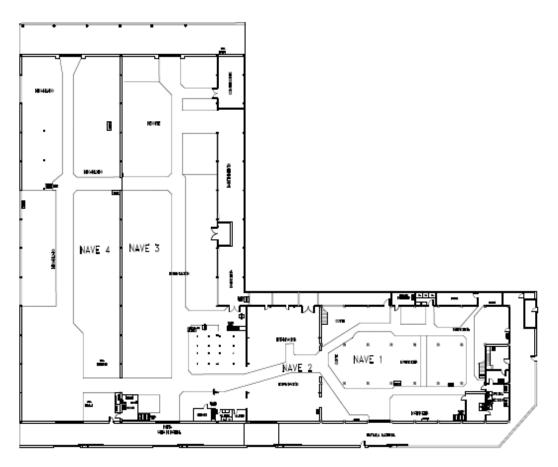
Plano de la distribución en planta. Fuente: AFSA.
